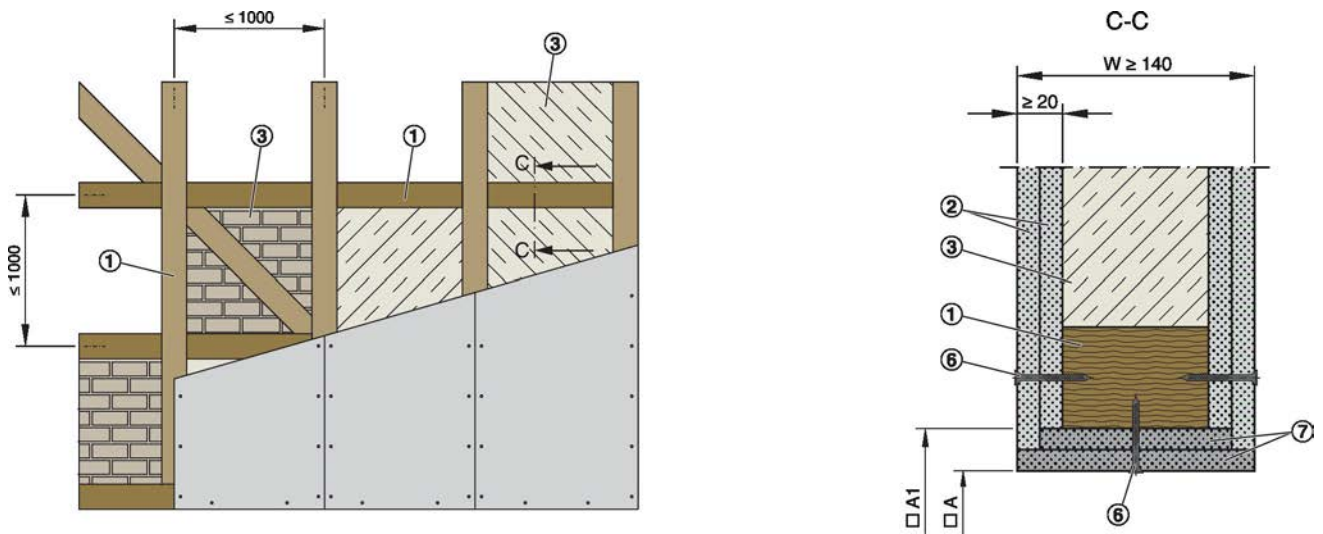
Pared ligera de sectorización con entramado parcial de madera y aislamiento a ambos lados
